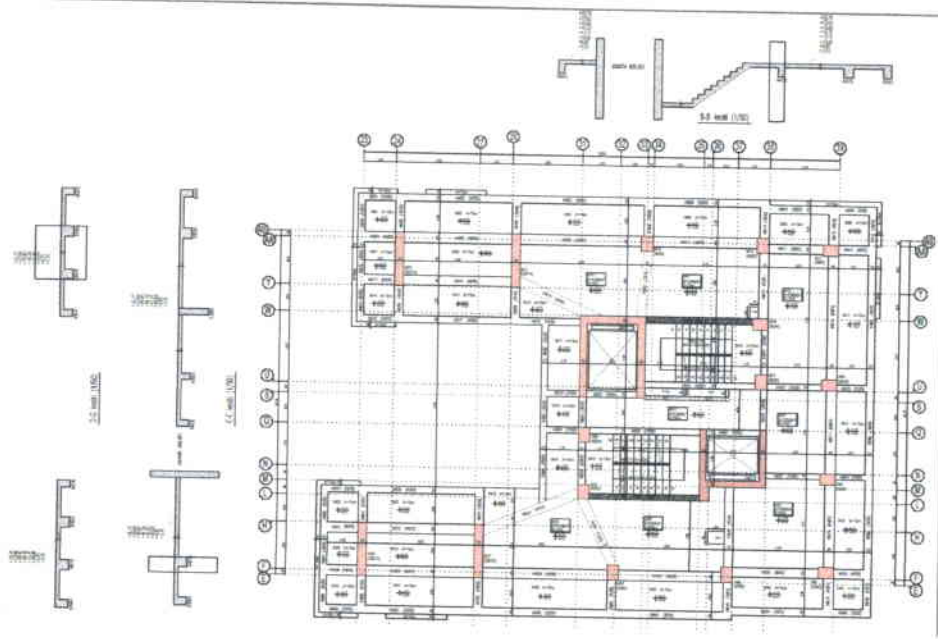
B Blok 3.Bodrum Kat Kalıp Planı
